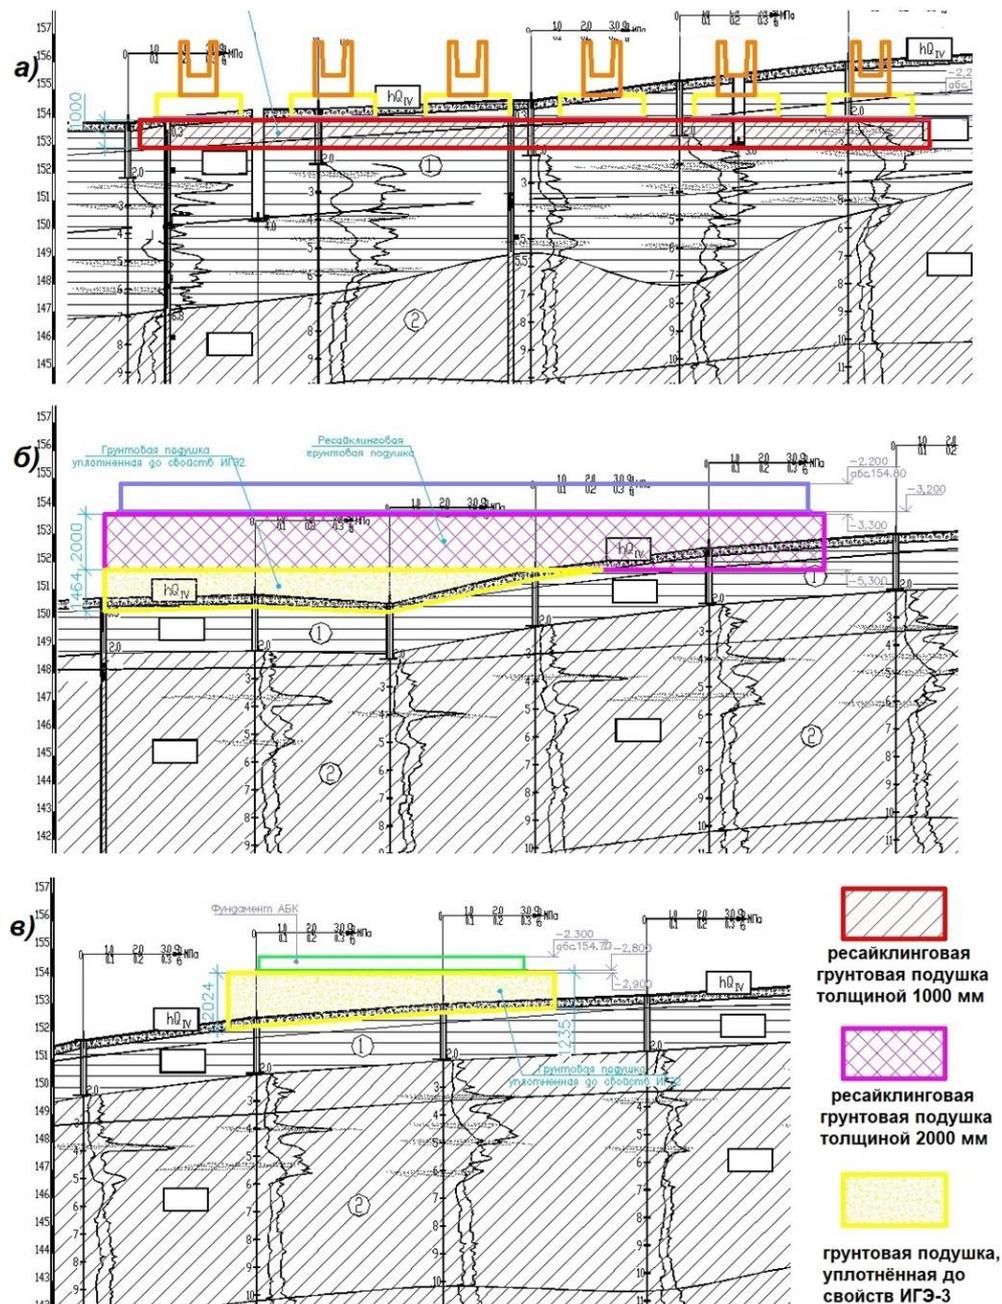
Посадка фундаментов на геологическом разрезе:
